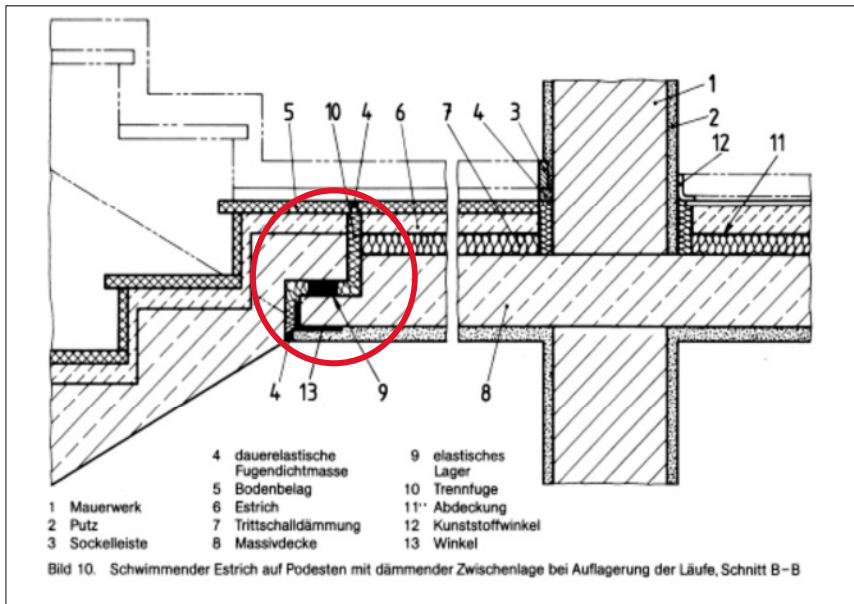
Entnommen aus: Bild 10 der DIN 4109 Schallschutz im Hochbau Beiblatt 1 (1989-11) mit unrealistischer kleiner Auflagerkonsole, in die man niemals Bewehrung einbringen könnte.
